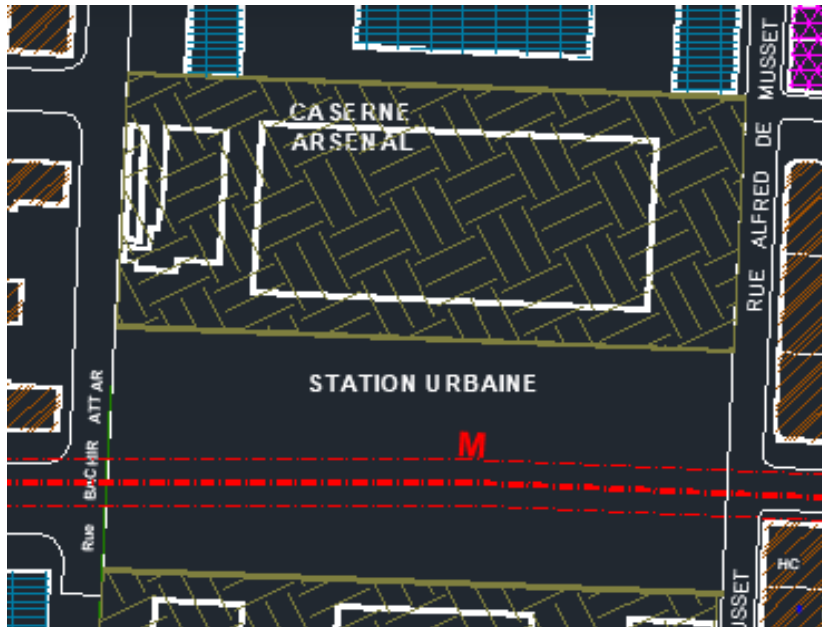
vue en plan de la station avant l'intervention /source :auteurs
